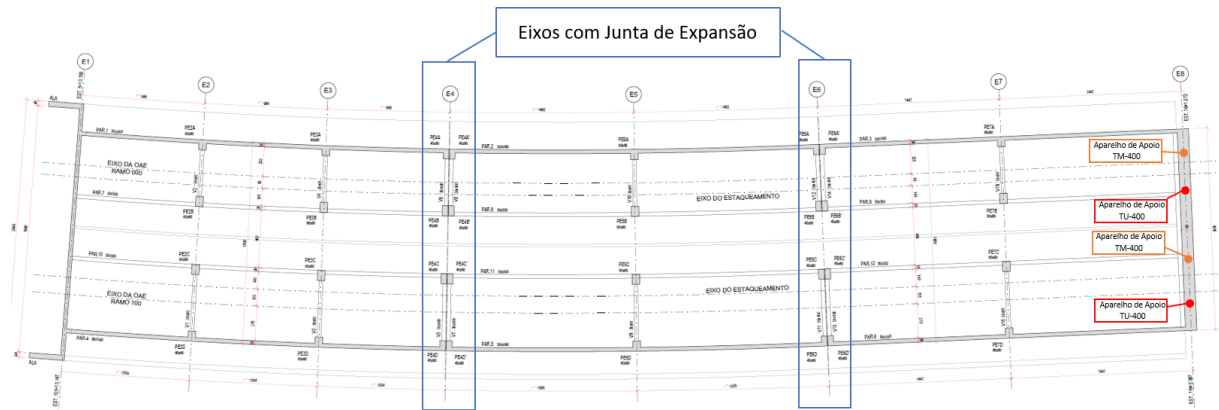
PLANTA ENCONTRO ESTRUTURADO (EIXOS E1 A E8)
